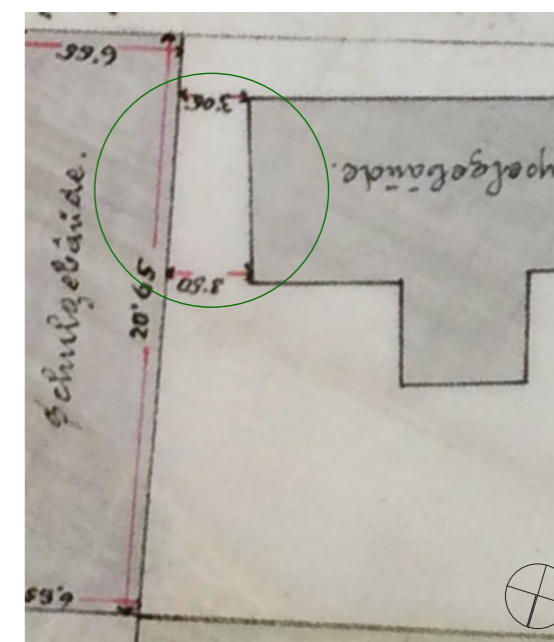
Lageplan Einreichung Aufstockung Schulgebäude (1892) [ma37]
